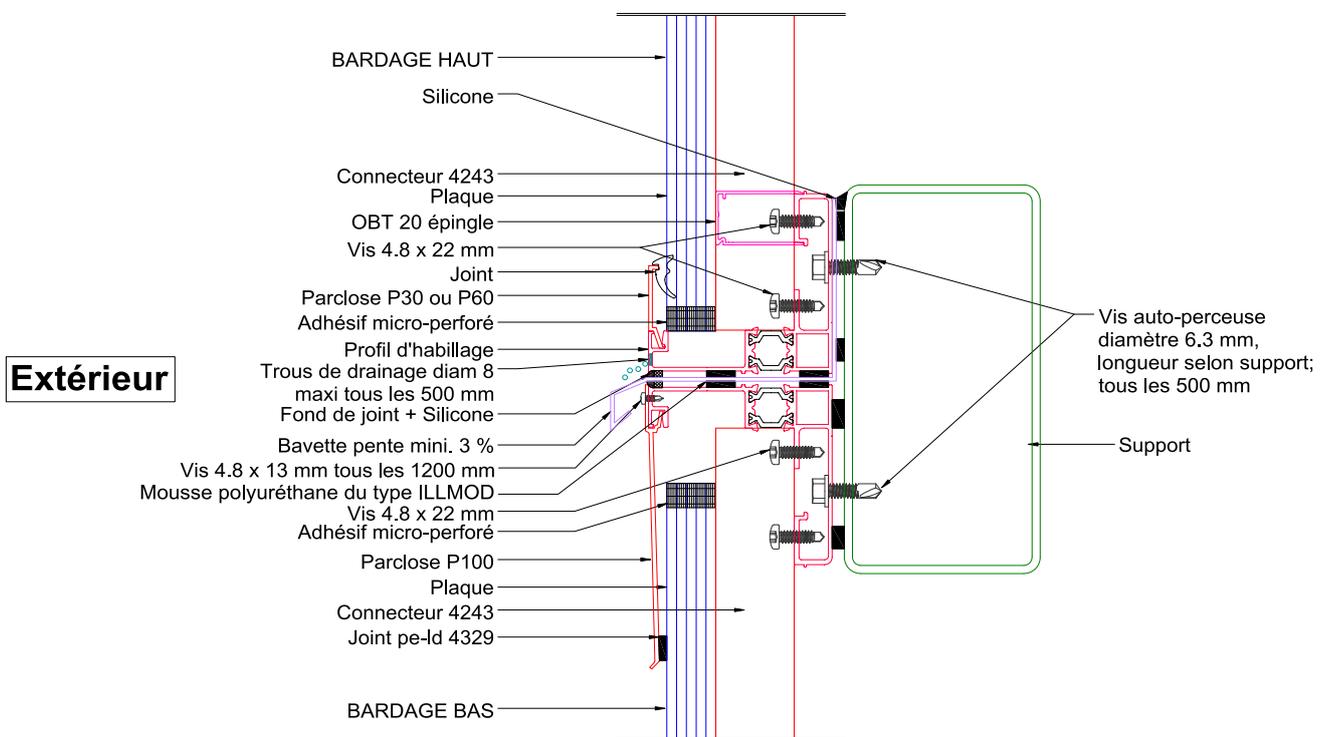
Principe pose avec connecteurs intérieurs - Raccord de hauteur n°2 : façade basse limitée à 10 mètres de haut
